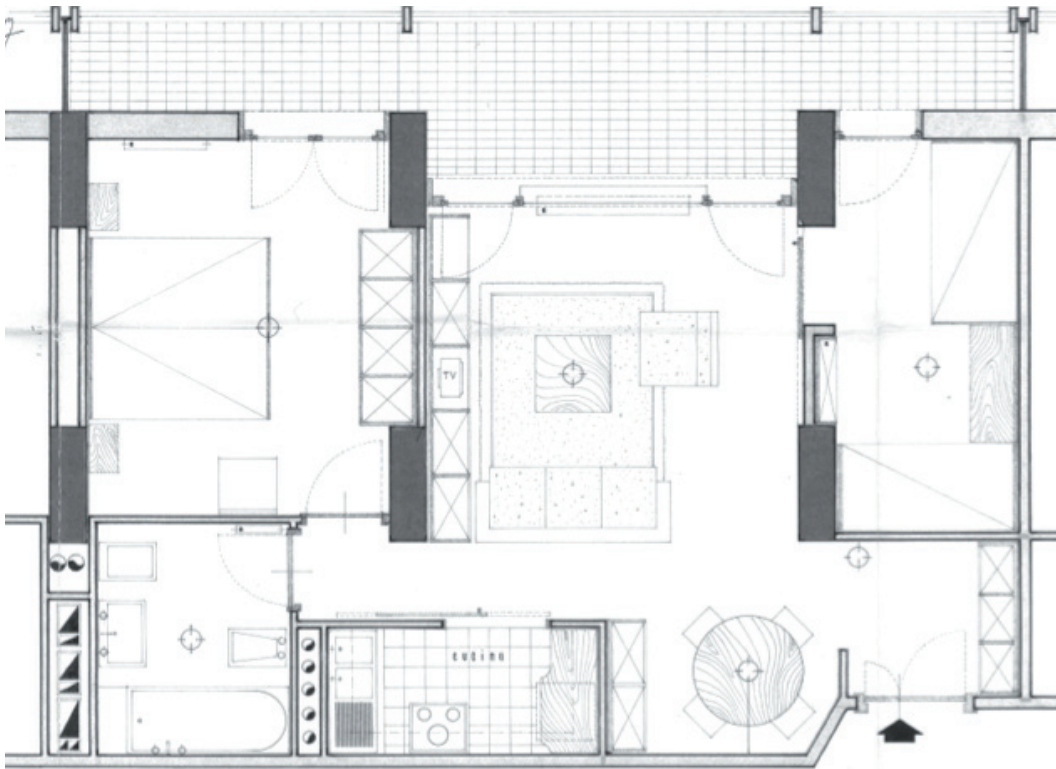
Grundriss einer Wohnung im Hotel House (Quelle: Cancellieri)
